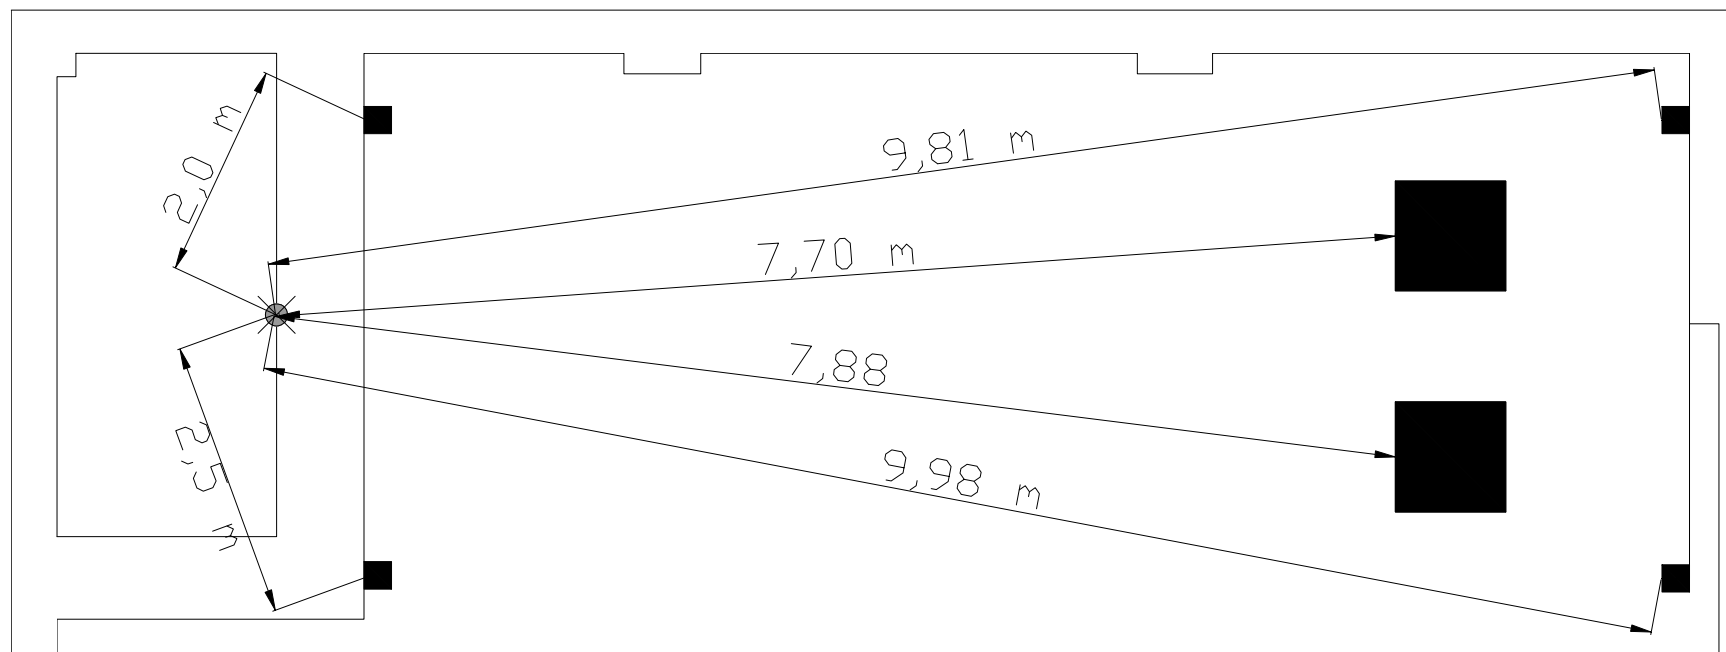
Pormenor do sonómetro e fontes sonoras na zona da pista de dança
